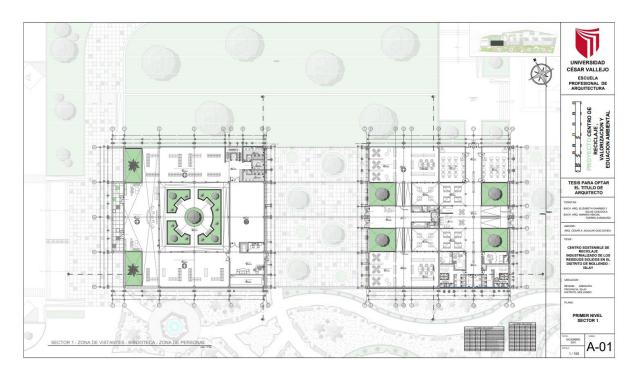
Planta de Distribución, Sector 1 – Primer Nivel FUENTE: Elaboración Propia
